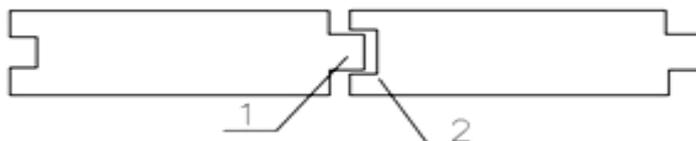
Деревянный или железобетонный шпунт для прямолинейных участков шпунтовых стен: 1 – гребень; 2 – паз
